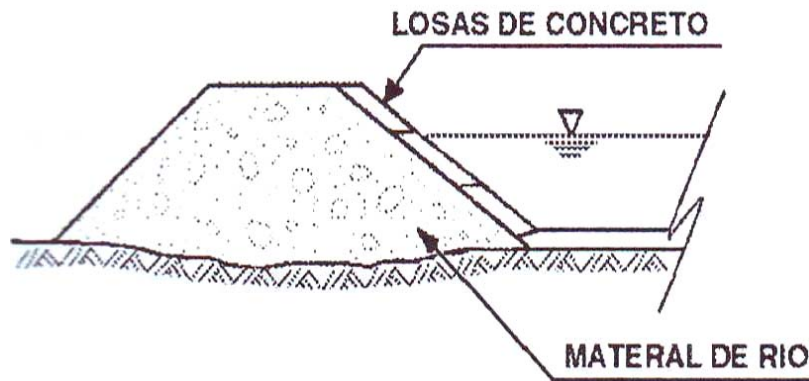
Losa de concreto armado colocadas en la cara húmeda de un dique
